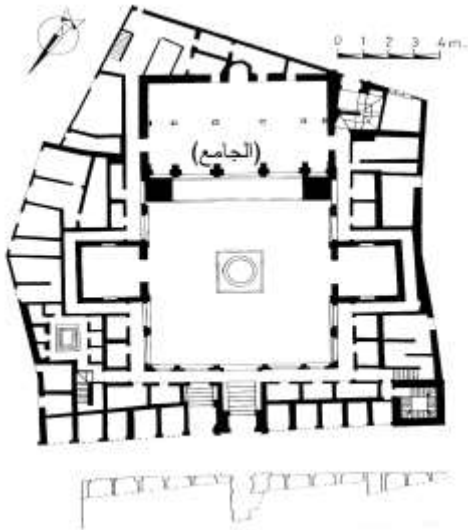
مسقط أفقي لجامع القرويين بمدينة فاس
